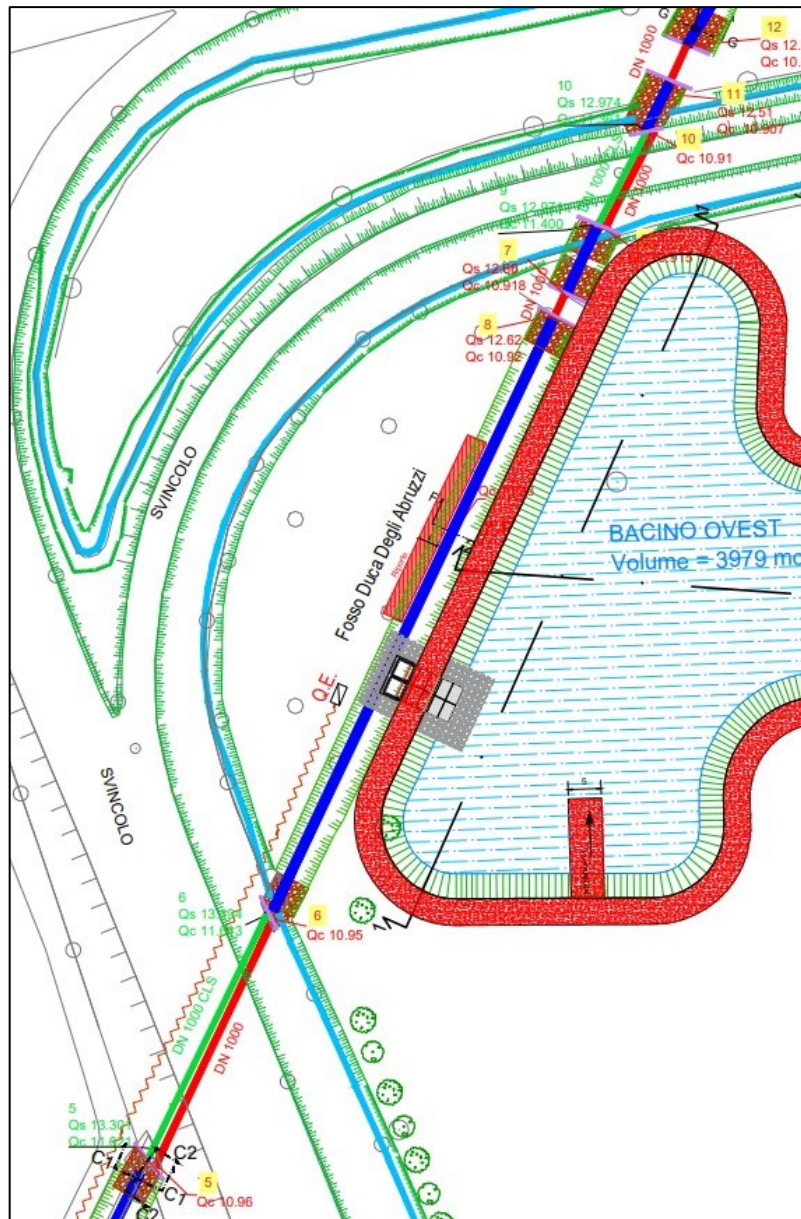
Planimetria 2 del fosso Duca degli Abruzzi
